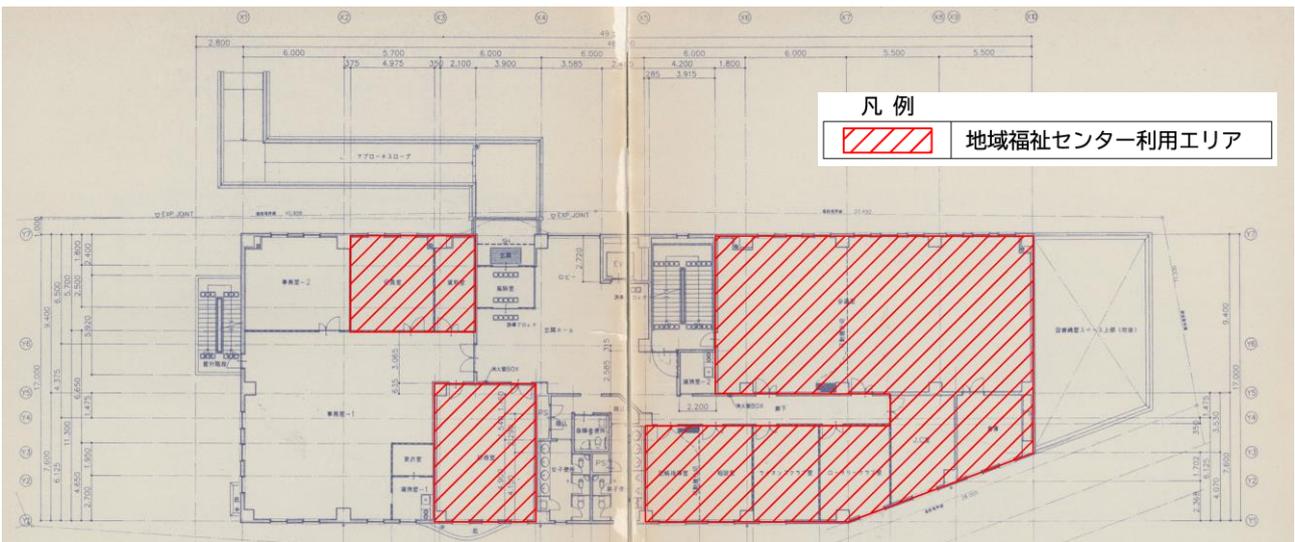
地域福祉センター 機能位置図 (案) 2階平面図
